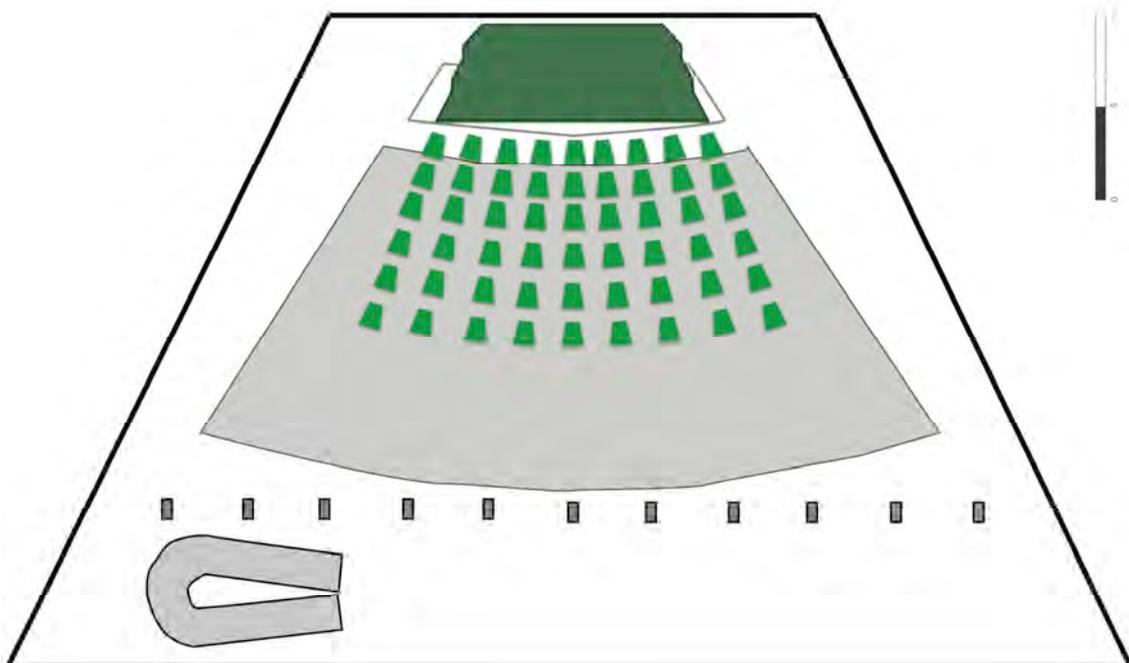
Planta da SV-L. Esquema da disposição de uma bateria de refletores/difusores sobre a platéia.
